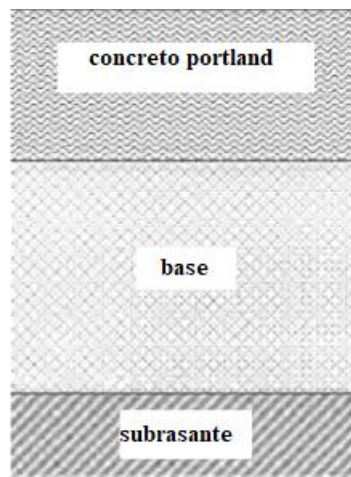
Estructura de pavimento rígido. Fuente: Elaboración propia a partir de (Papagiannakis et al., 2008)
